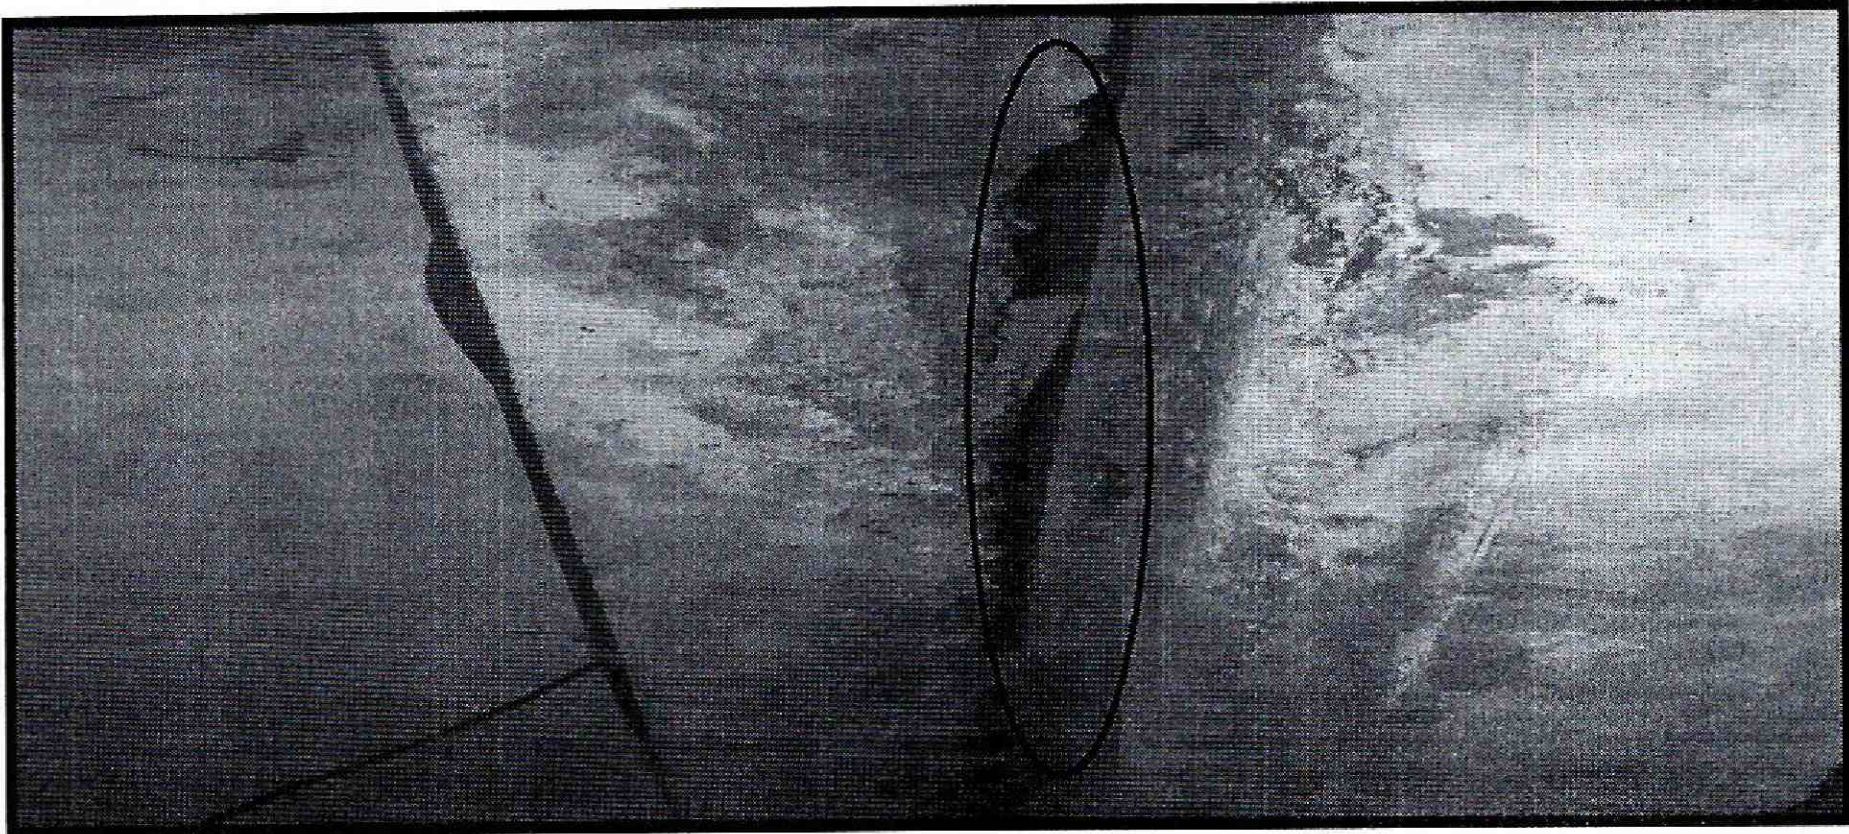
y 11. Fisuras en columnas de tendencia diagonal en su parte media con esperones menores al milímetro en el sótano.
